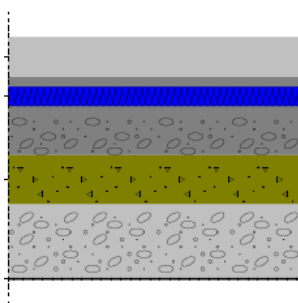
Pormenor do pavimento – Laje\_1.
